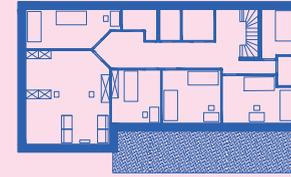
Plan du Foyer de Meillerie, 1er, 1:500, 2022
